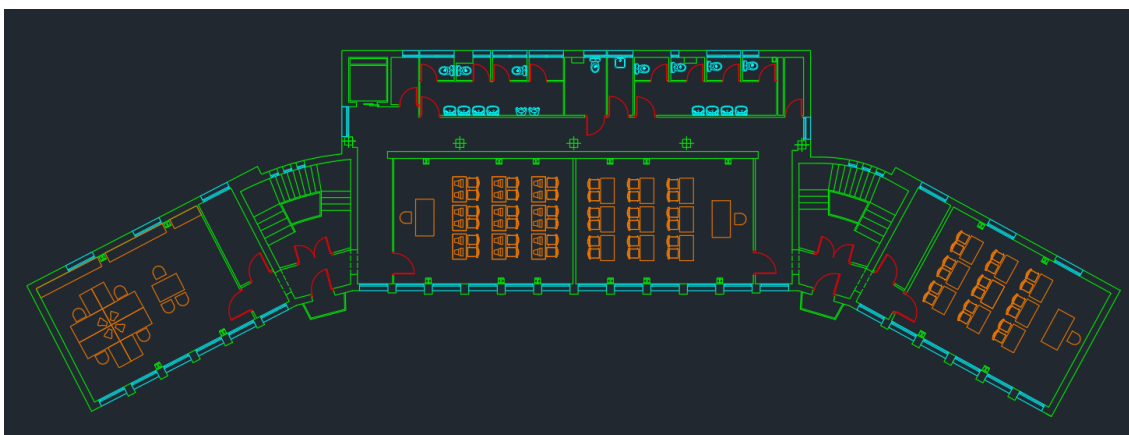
Plano de la planta 1 revisado sin cotas
